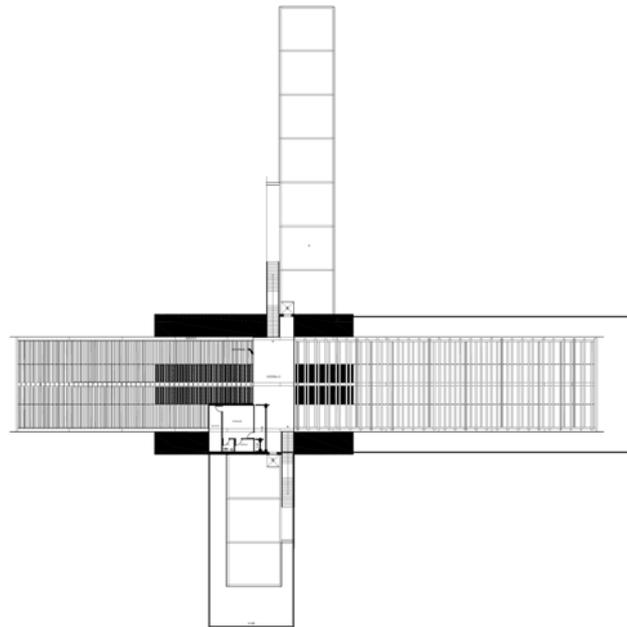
Planta nivel de vestíbulo para estación tipo elevada
